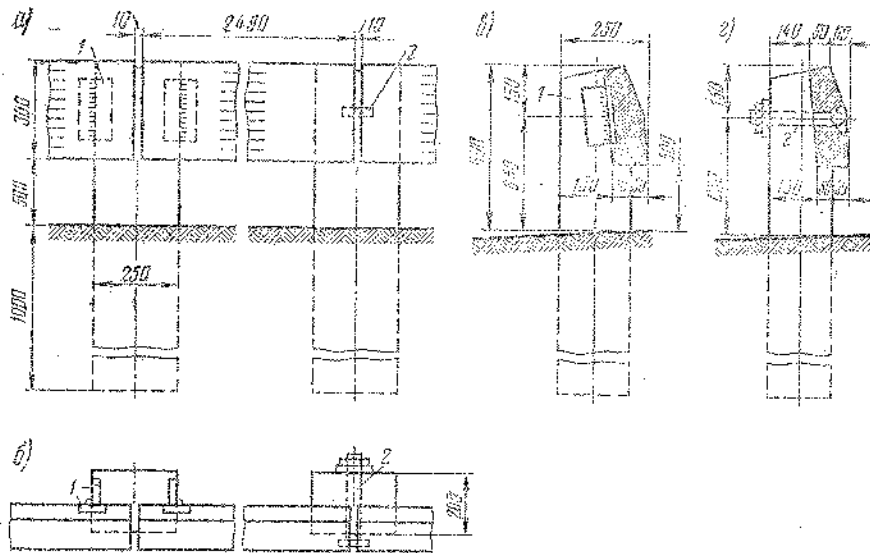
Конструкция железобетонного балочного ограждения:
